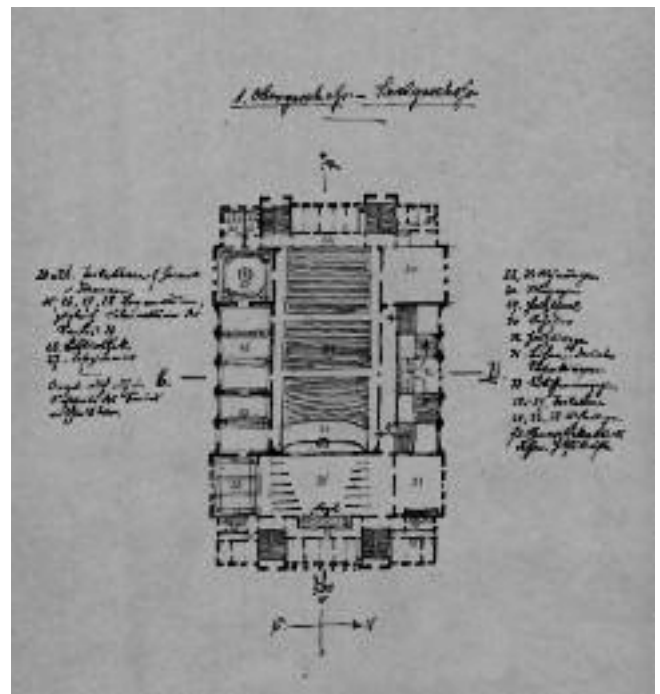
Alois Haase: Entwürfe für einen Theaterbau (Grundriss Saalgeschoß), Frühjahr 1910. Rudolf Steiner Archiv
